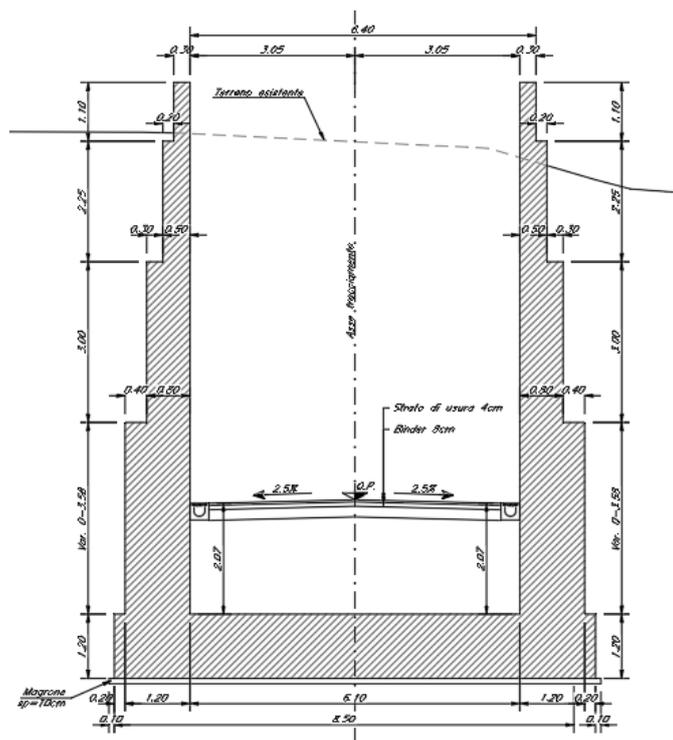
Sezione trasversale concio 6 ovest, in corrispondenza della sezione di massimo scavo
